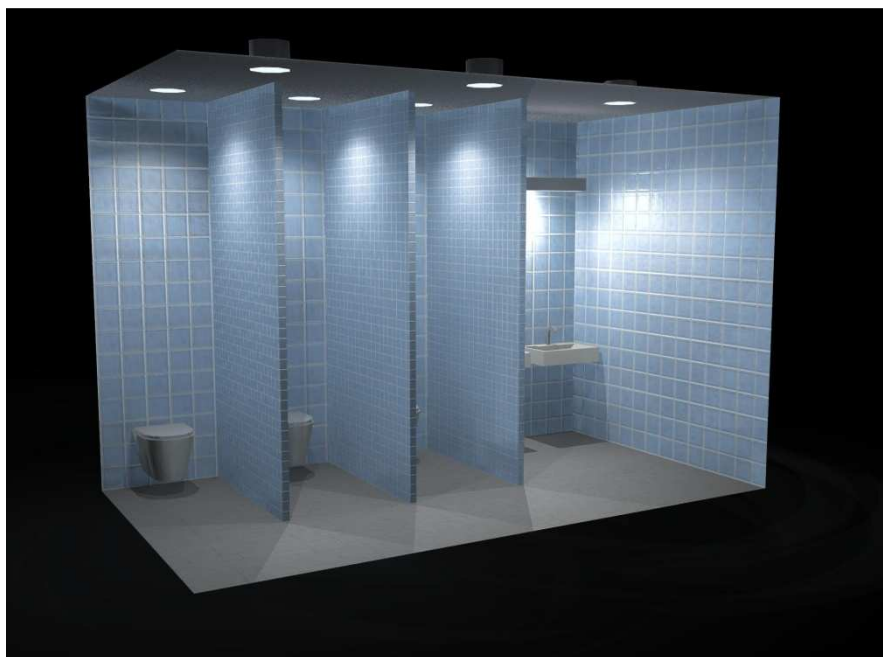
Estudio de Iluminación de Baño en Planta Alta.
